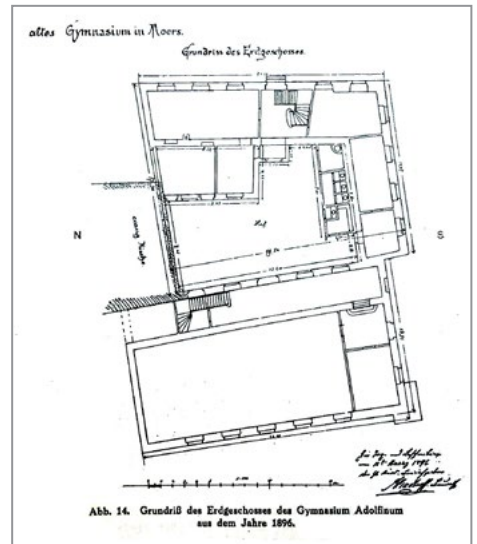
Grundriss des Erdgeschosses des Gymnasium Adolfinum aus dem Jahr 1896
